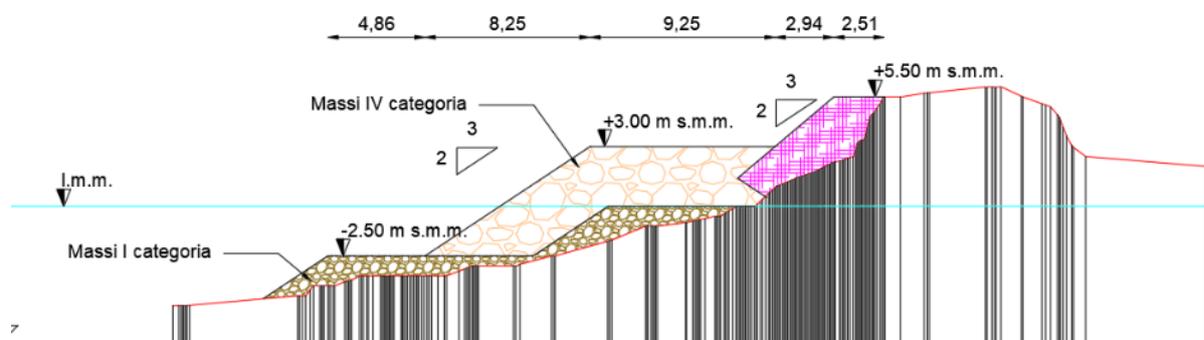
Sezione tipo del tratto compreso fra la sezione 5 e la sezione 7
